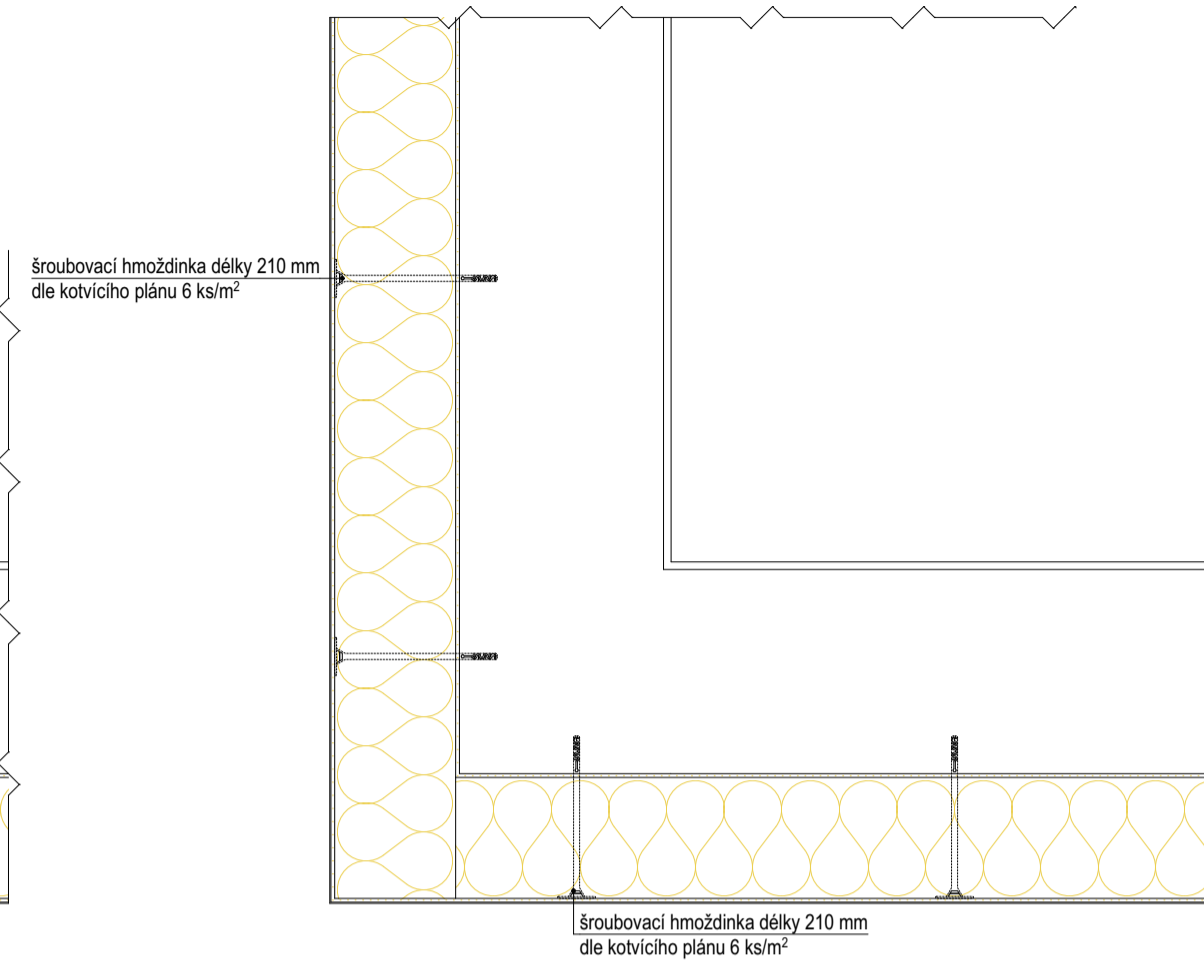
## DETAIL - ROHOVÉHO KLADENÍ ZATEPLENÍ
